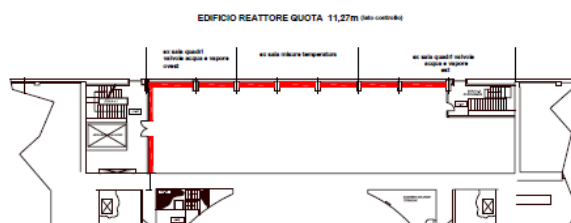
Planimetria Edificio Reattore quota 11,27 m s.l.m.m - strutture portanti di rinforzo strutturale
